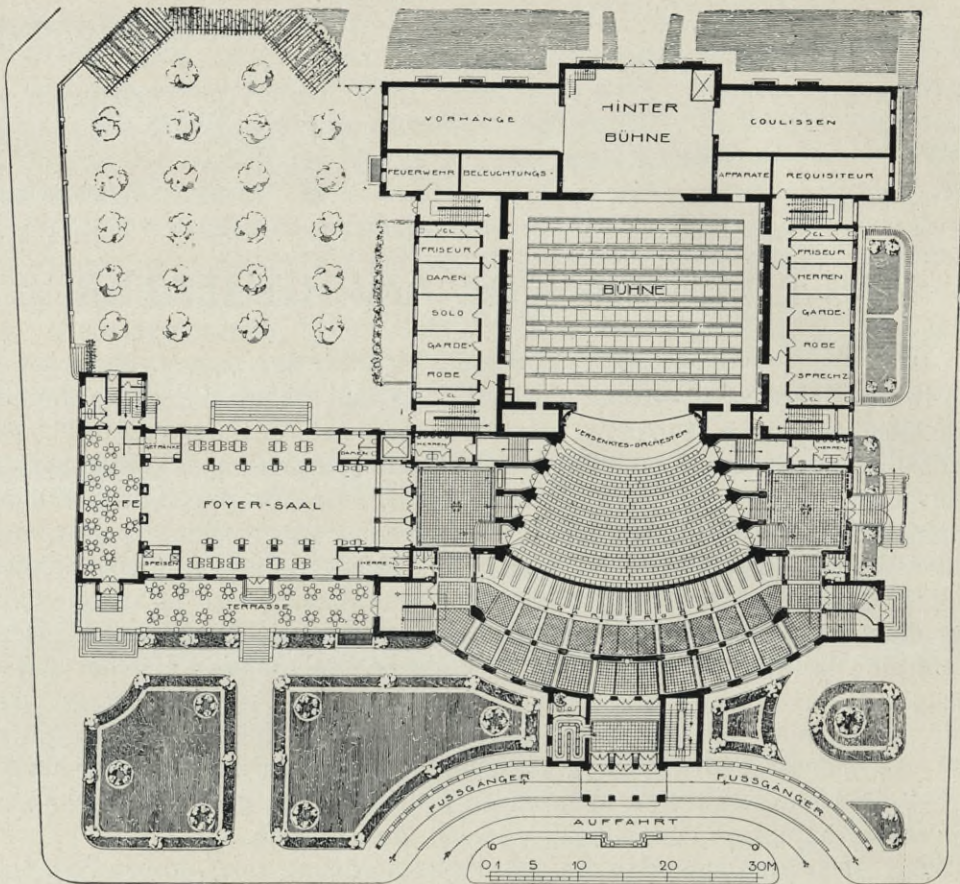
Das Prinzregententheater zu München. Grundriß. 117)
